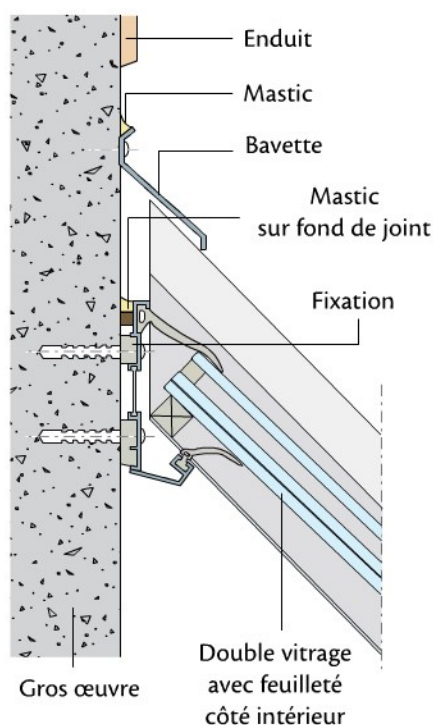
Étanchéité à l'eau, cas d'une structure avec assise murale
